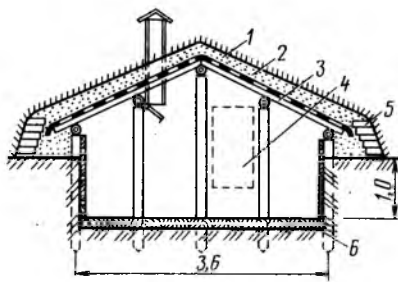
Полузаглубленное хранилище (овощной лабаз): 1 — обваловка грунтом; 2 — рубероид; 3 — дощатая обрешетка; 4 — дверь-лаз; 5 — дерг; 6 — глинобитный пол
